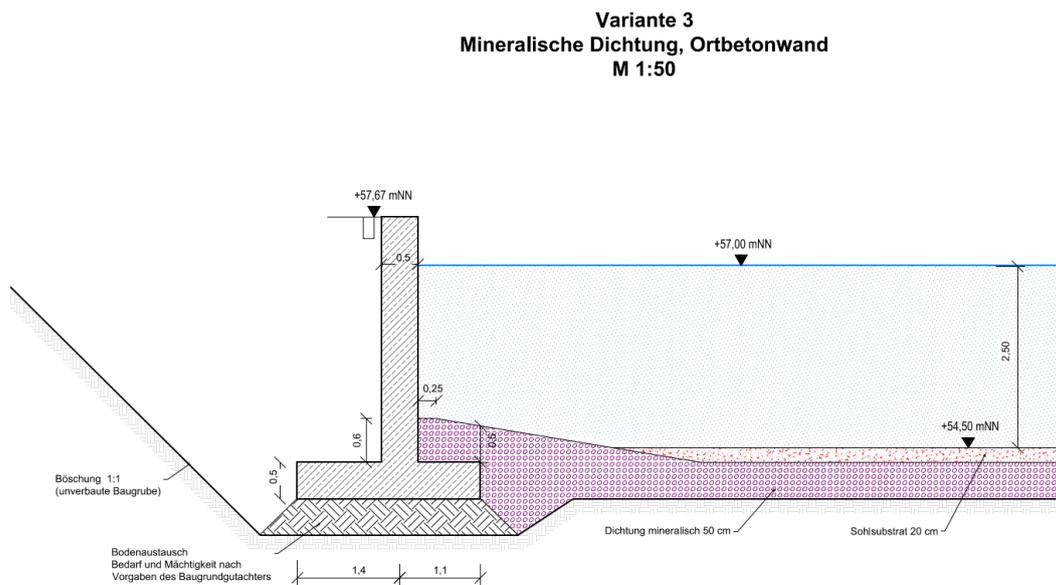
Variante 3, Uferbefestigung aus Ortbeton und mineralische Abdichtung
